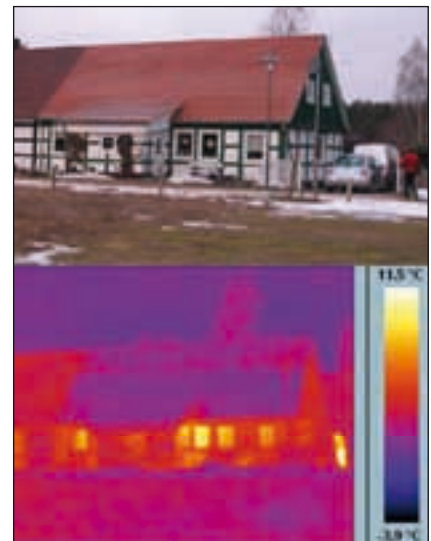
Fachwerkhaus, Baujahr ca. 1850
